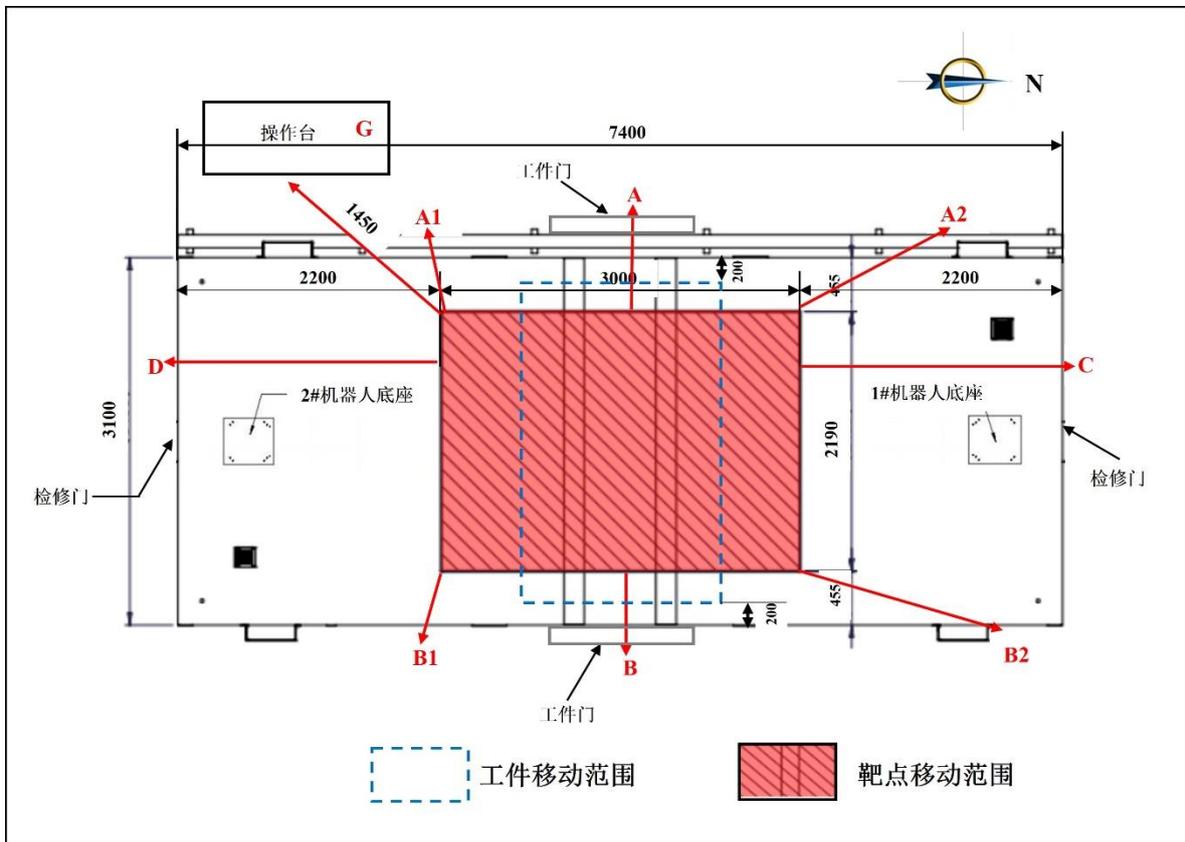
辐射屏蔽计算预测点位剖面图（单位：mm）
